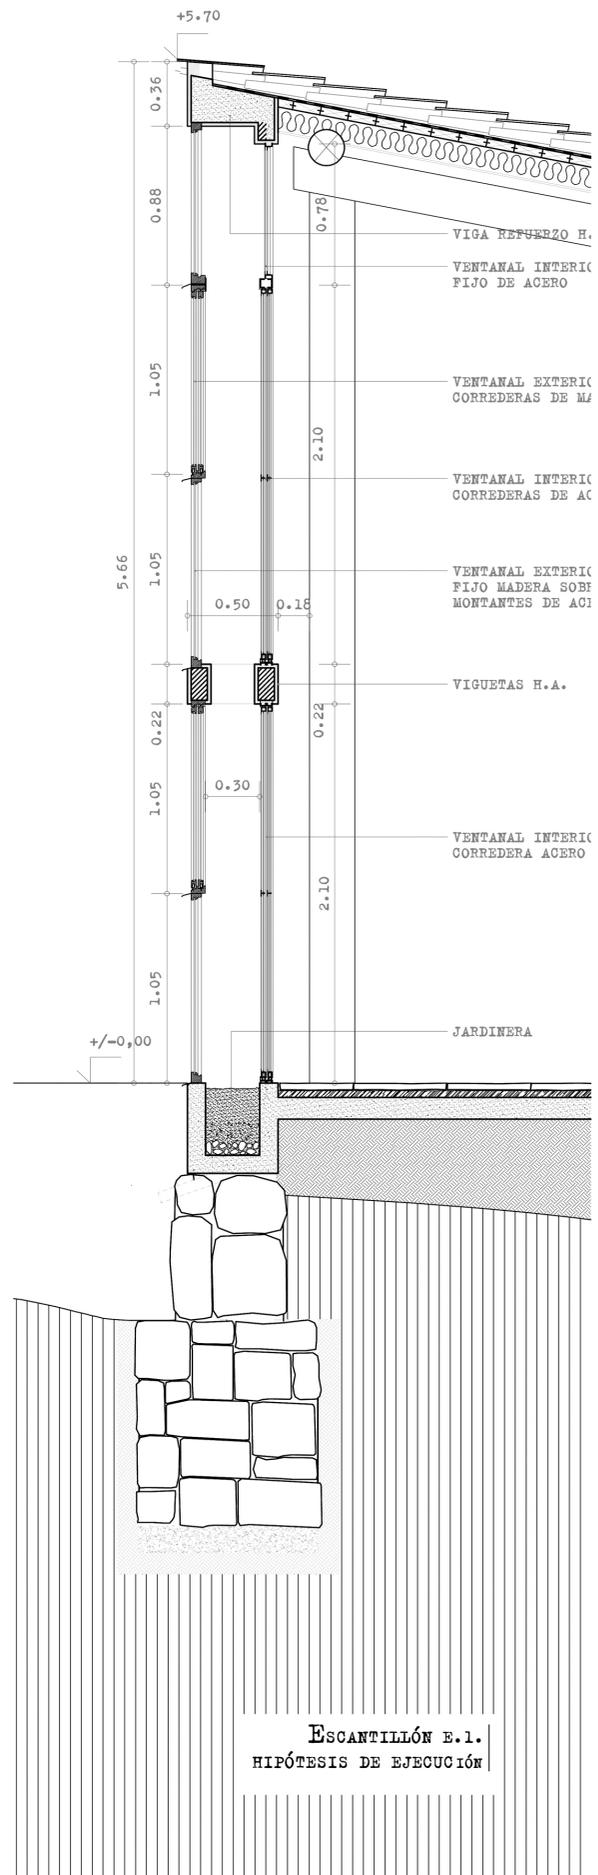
Escantillón propuesta de muro neutralizante para la fachada norte de la Casa Errázuriz. Dibujo Thania Labarca y Felipe Moreno.
